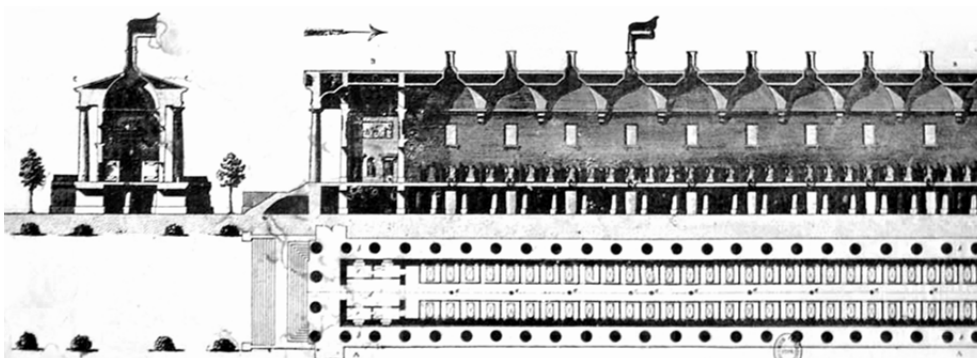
Corte e planta de um dos pavilhões do projecto de Leroy para o Hôtel-Dieu de Paris (1773)
